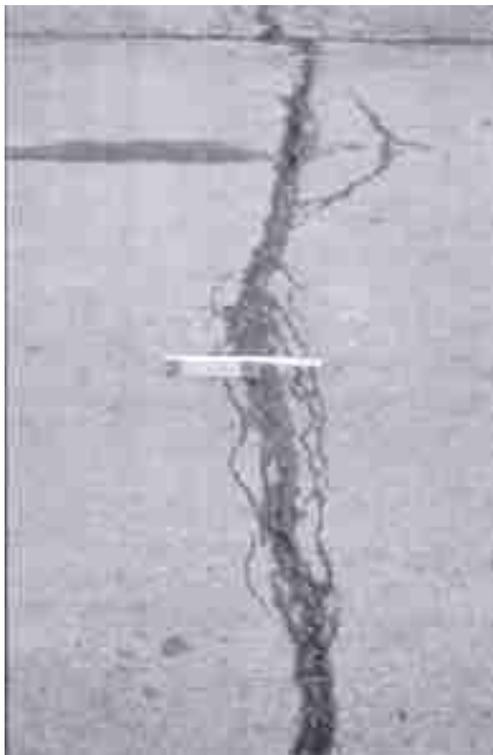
Falla Fisuramiento de Reflexión – Severidad Baja
